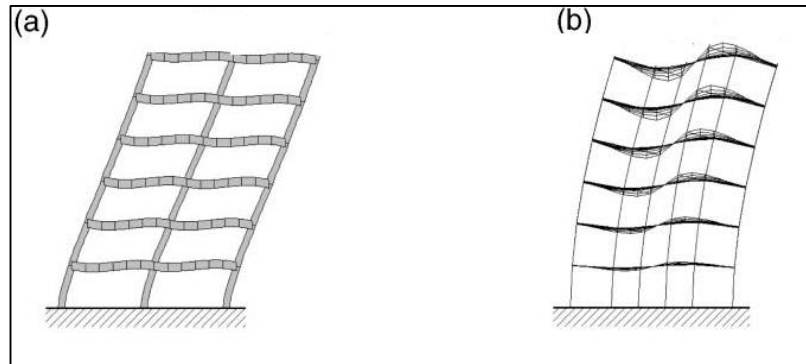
Forma deformada de la construcción de estructuras por las cargas laterales. (A) Tipo de plano A, (b) Tipo de plano B.
